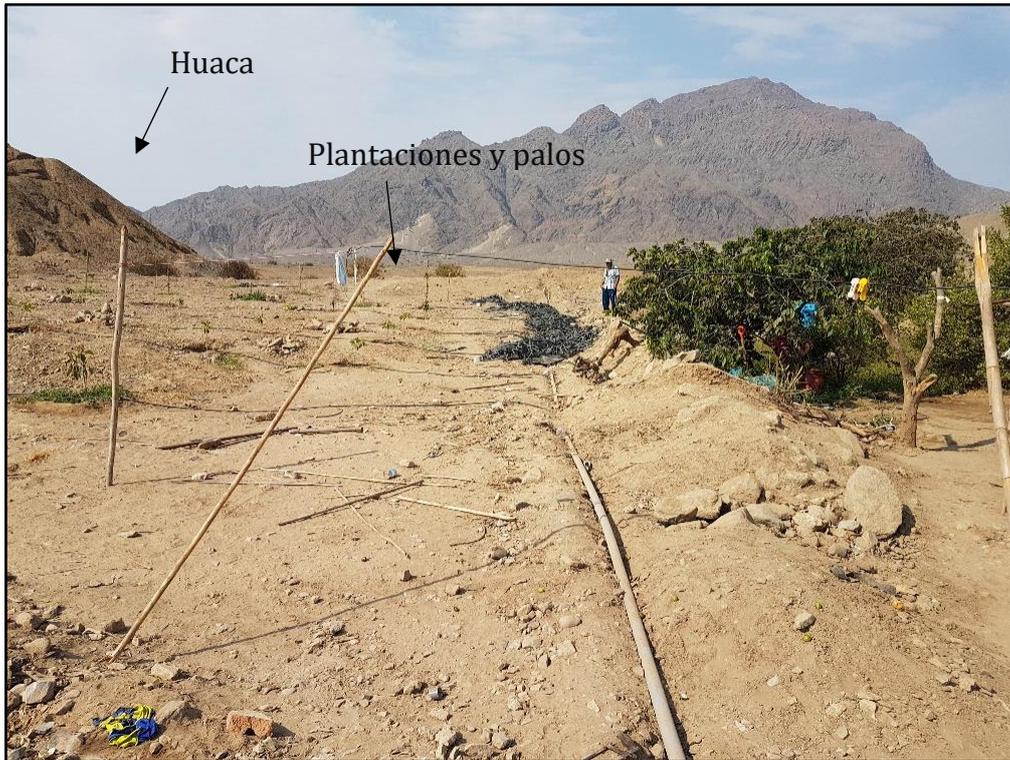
Vista de Sur a Norte. Manguera instalada dentro de la excavación. A la izquierda se aprecia la huaca y las plantaciones
